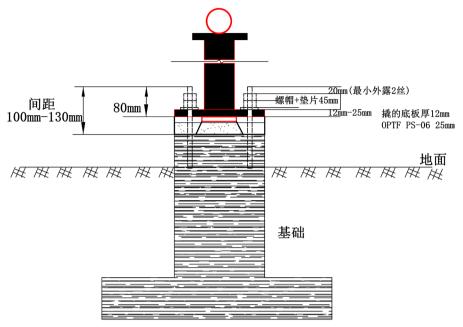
Foundation elevation diagram 图 3. 基础标高示意图
